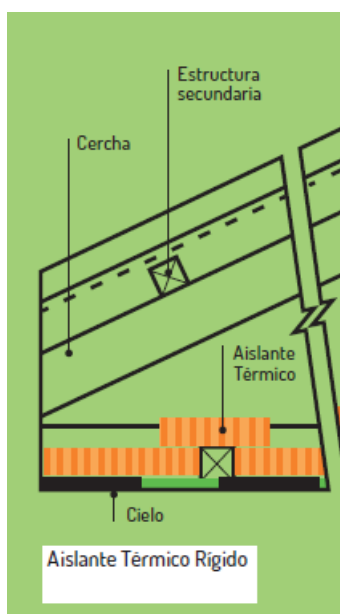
Detalle techumbre, sección plano elevación Proyecto DS N° 10 de la empresa ICUFER Construcciones Ltda.
